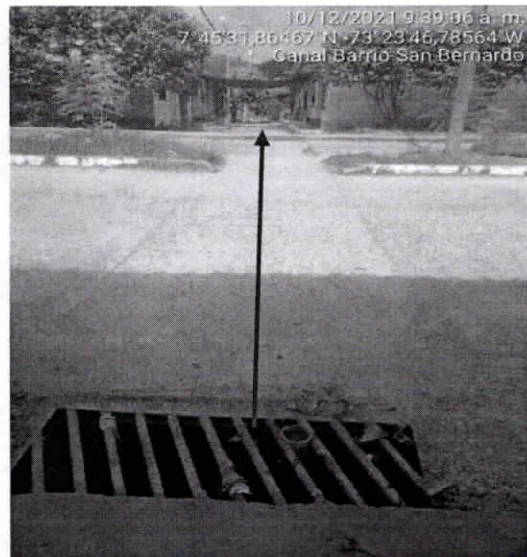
Alcantarillado Pluvial Diagonal 2c entre carrera 8 y 7a del barrio San Bernardo.
